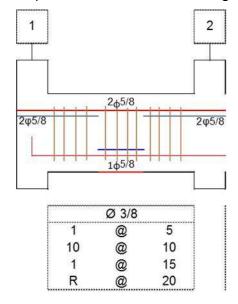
Diseño final de la viga V-102(0.25x0.50) m
